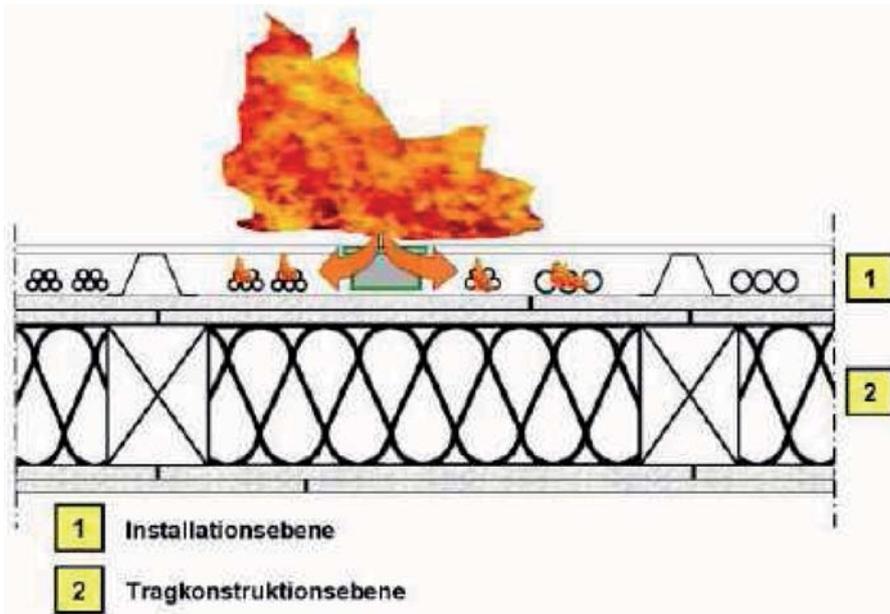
Führung von Installationen vor REI 60 Bauteilen in Holzbauweise
